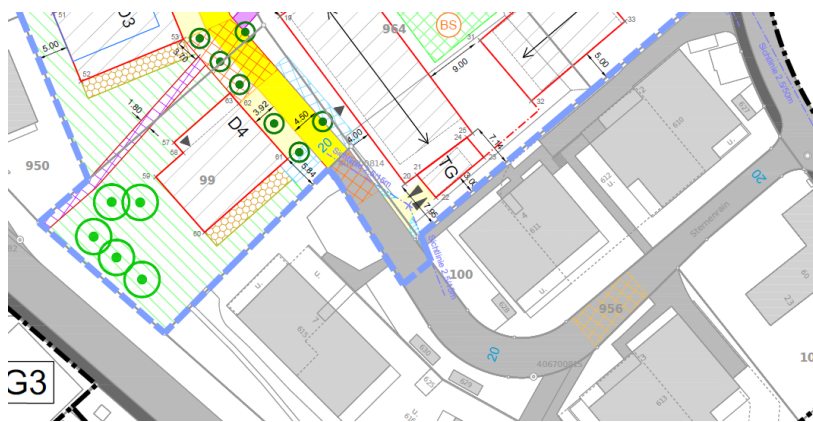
Ausschnitt Situationsplan - Baubereichsgruppe D
